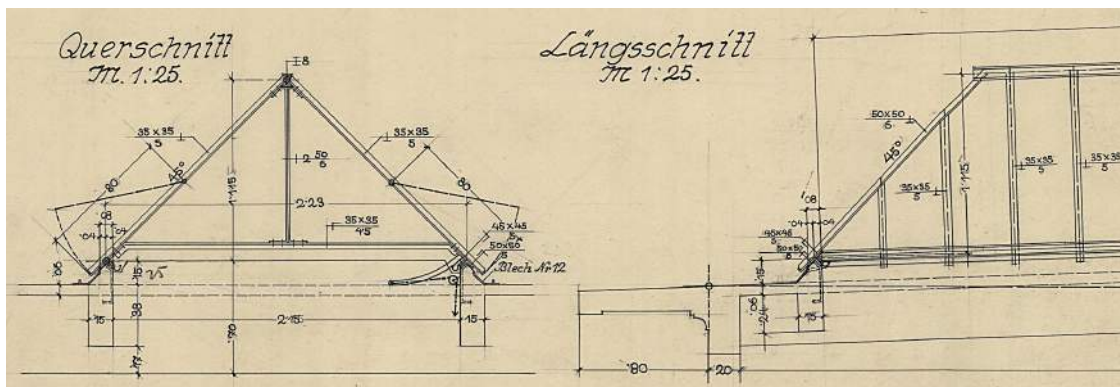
Planausschnitt aus dem Detailplan für die Dachoberlichter; Juni 1914
